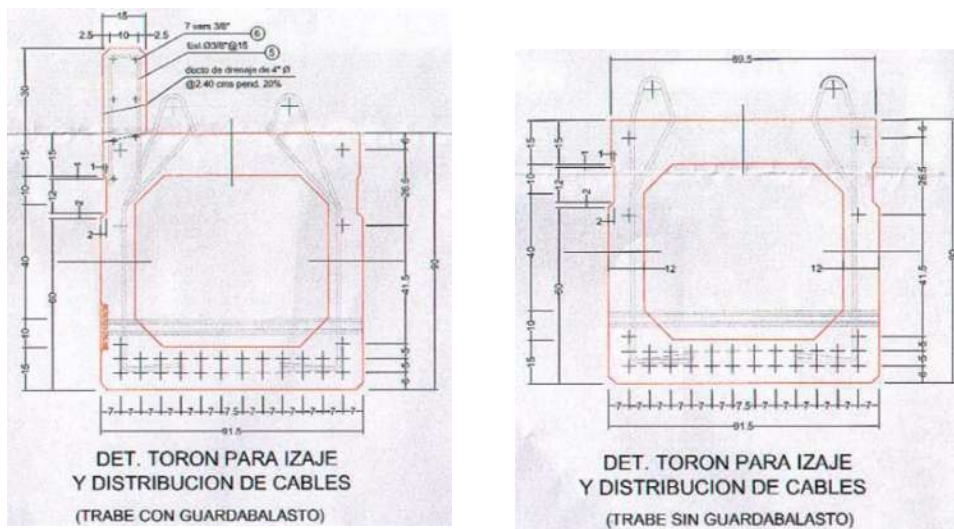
Geometría de las traveses cajón de concreto presfuerzado de proyecto.
